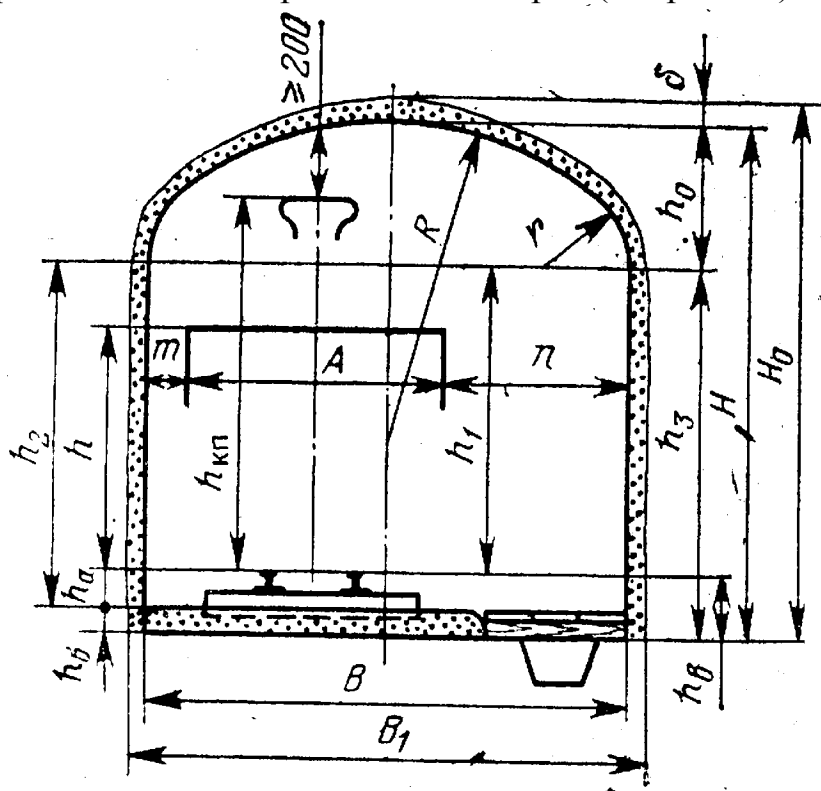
Сечение выработки прямоугольно-сводчатой формы с набрызгбетонной крепью (расшифровку обозначений см. ниже)
